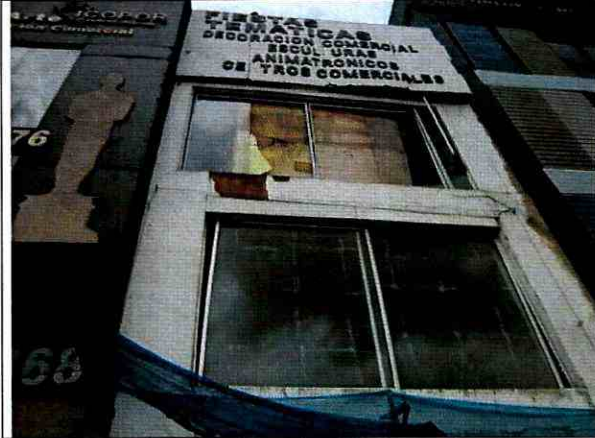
Grietas y deformaciones del muro de fachada.
